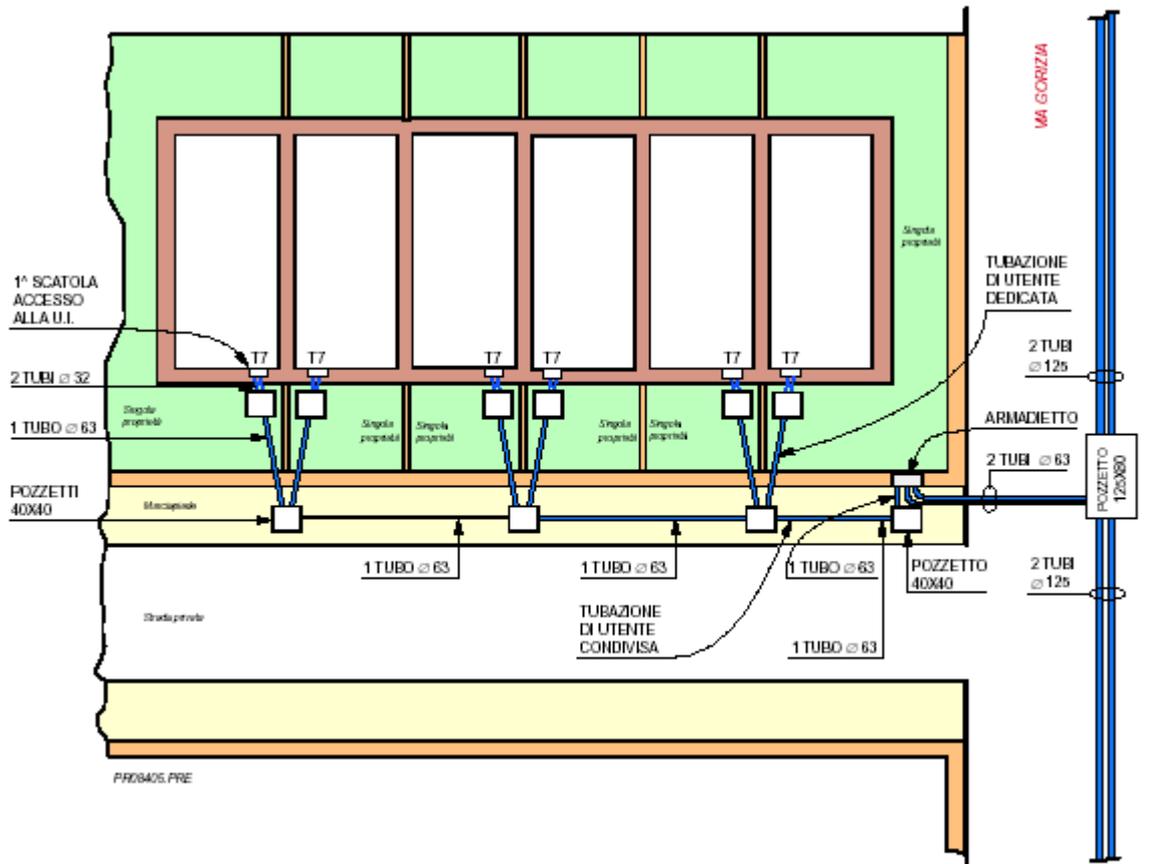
Esempio di predisposizioni tipo case a schiera con armadietto
